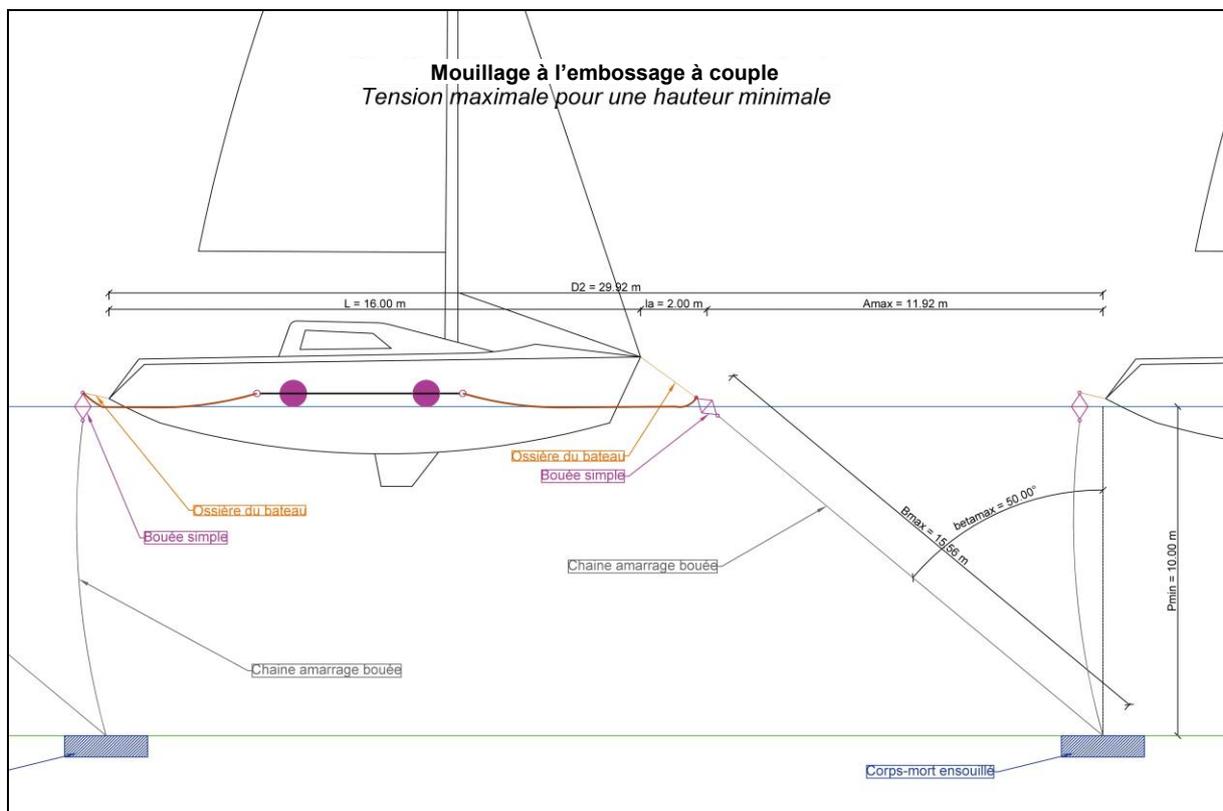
Coupe type d'un mouillage à l'embossage à couple avec bateau
